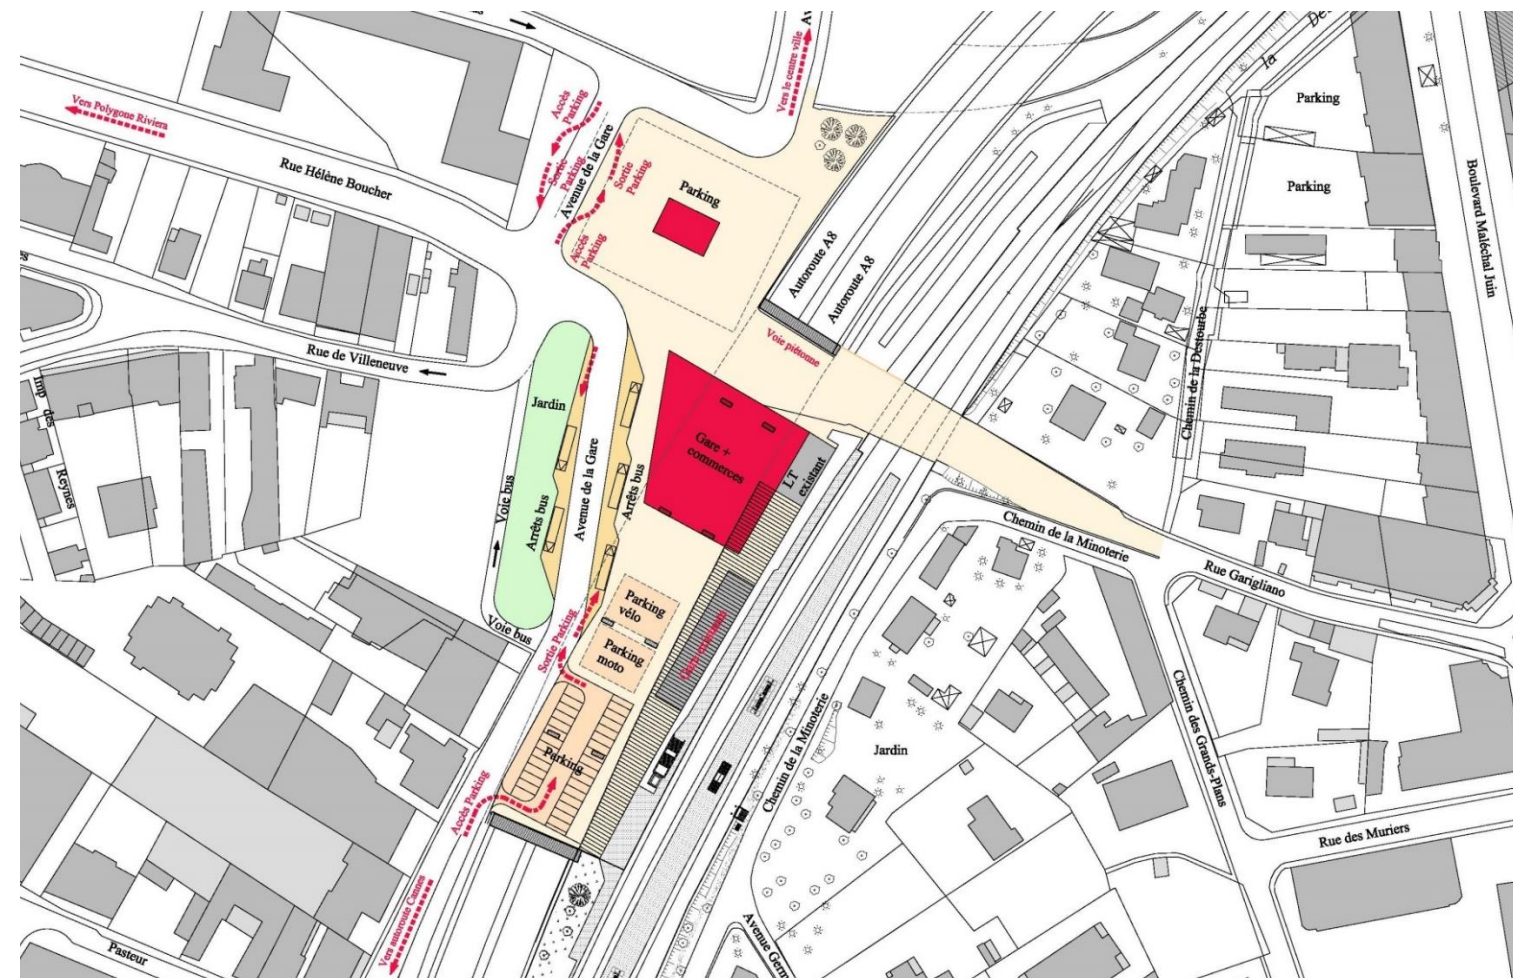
Variante 2 - plan (AREP – sans échelle)
